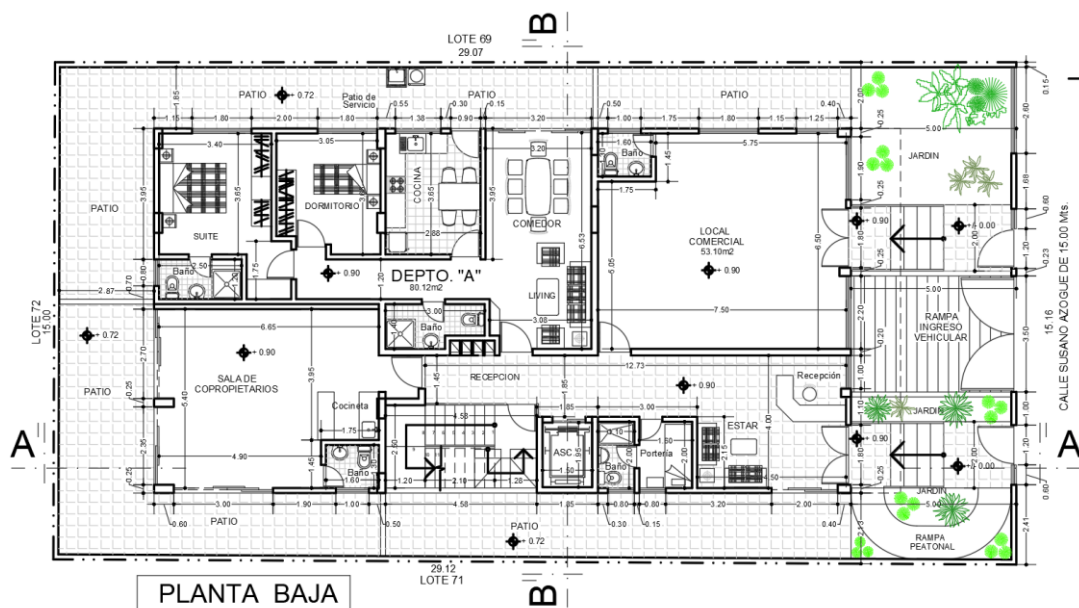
Plano arquitectónico Planta Baja. [12]
